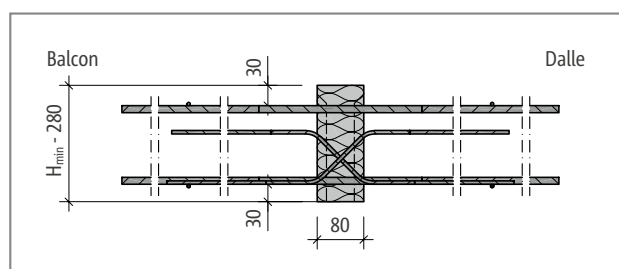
Schöck Isokorb® T Type D pour R0 : Coupe du produit
